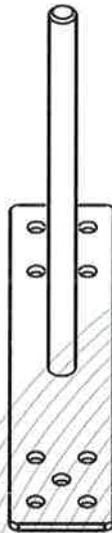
Anschlagereinrichtung, Typ: ZS 300-800 FIRST gerade, mit gerader Grundplatte (60 x 280 mm)
